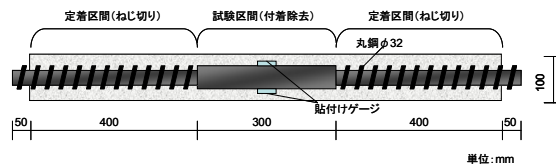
鉄筋埋設ひび割れ試験体概要図
